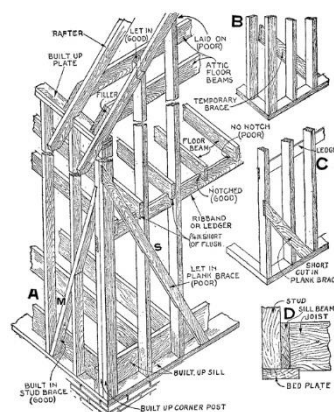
Esquema do "balloon-frame" - Audel's Carpenter's and Builder's Guide 1923
